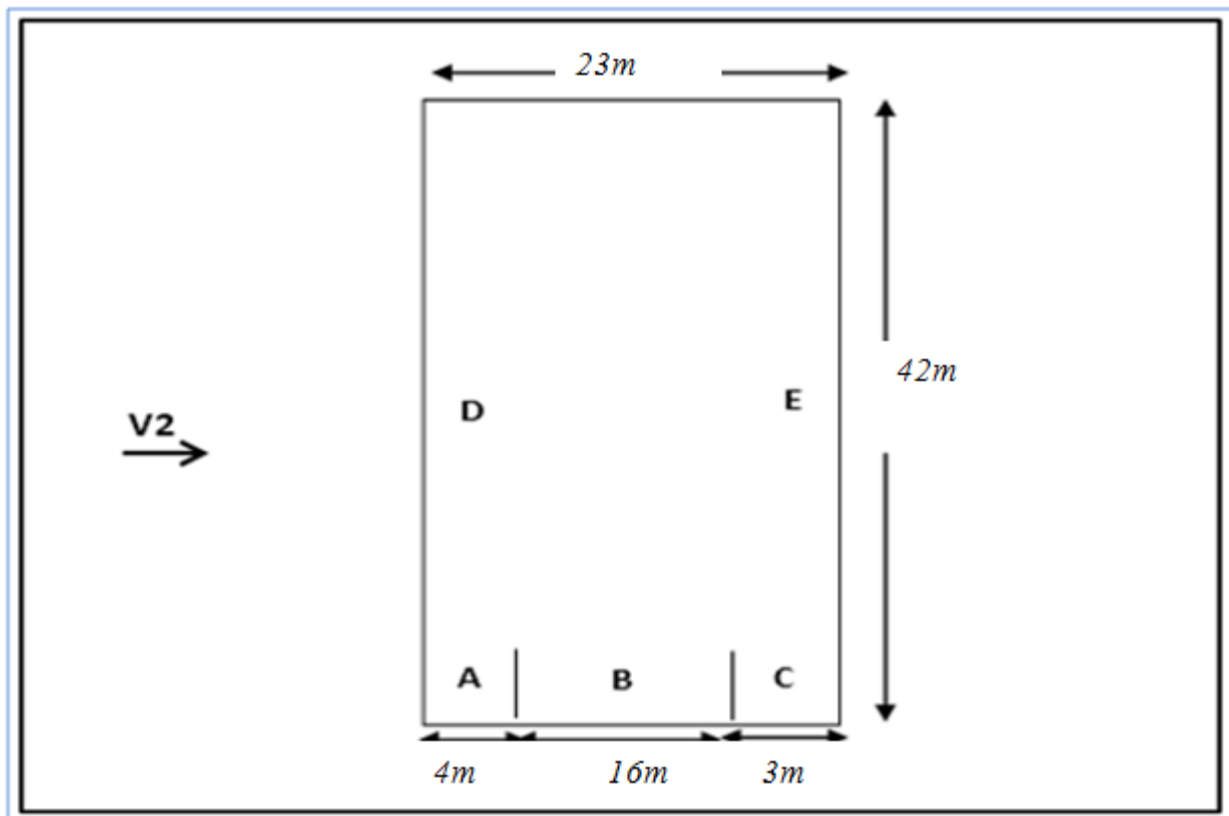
Vue en plan des zones de pression sur les parois verticales sens V2.
